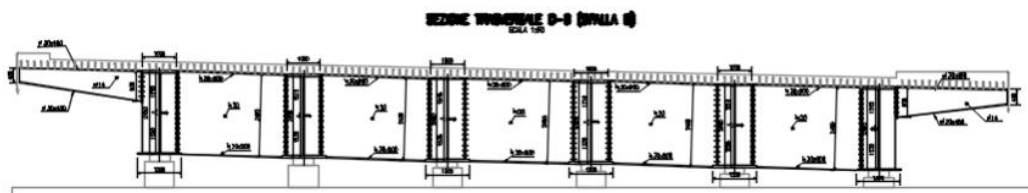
Struttura impalcato - Sezione trasversale spalla SpB
